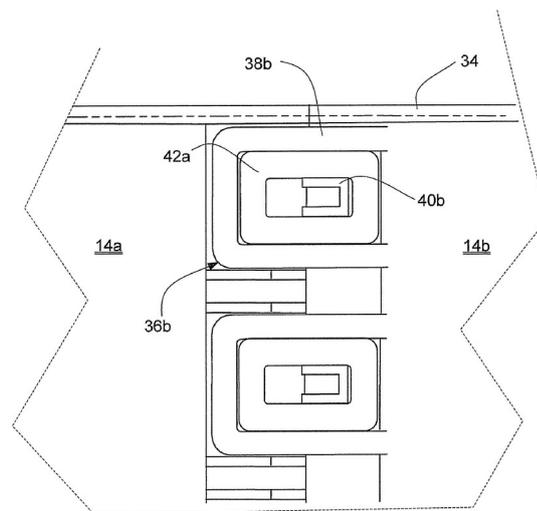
Детализованный чертёж замковой части подпорной стенки сегментного типа
